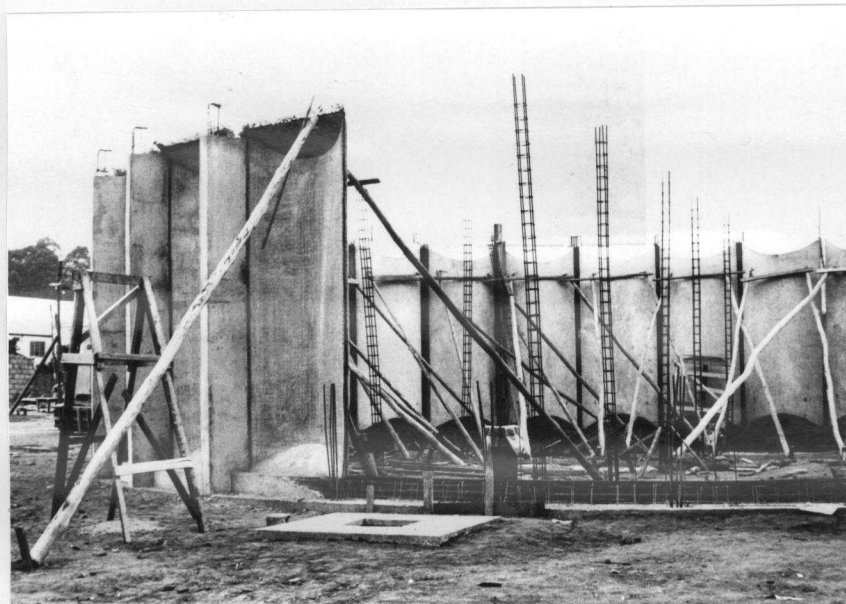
Reservatório de parede ondulada com elementos pré-moldados de argamassa armada^{6 7}
